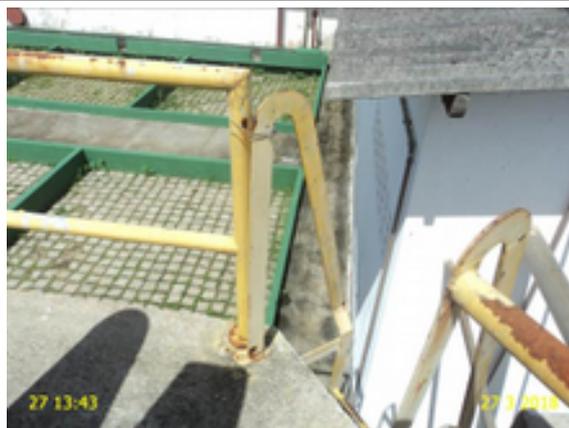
ETE Pajuçara: armaduras expostas na estrutura do decantador.
